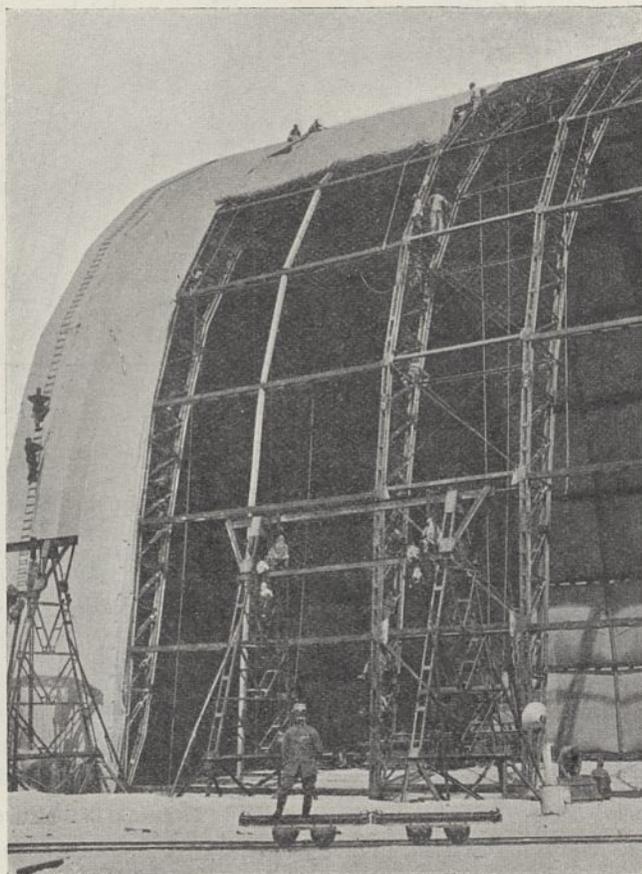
Versetzbare einschiffige Halle in Eisen.
